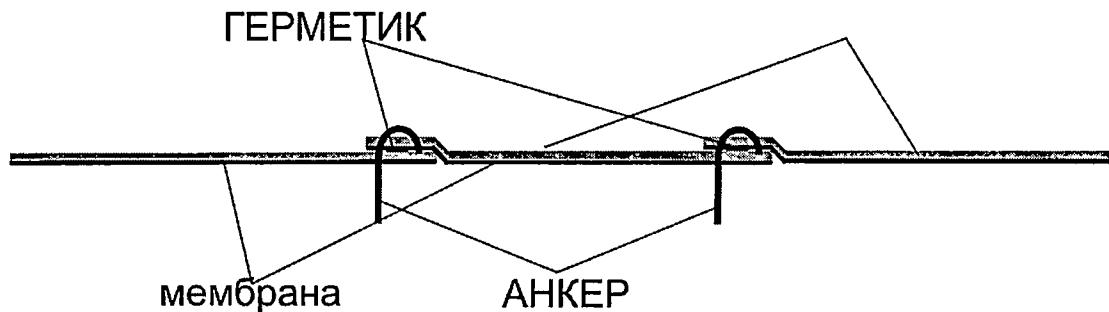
Схема укладки полотна БЕТОРОЛ
